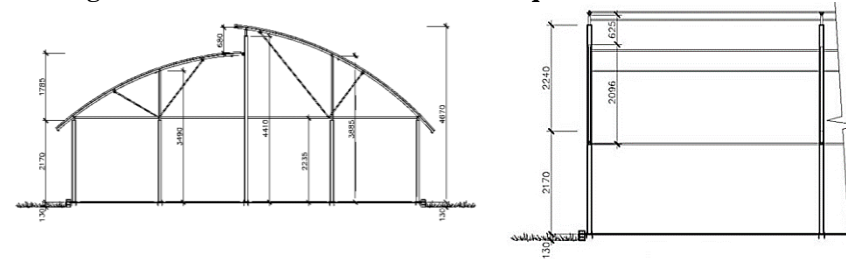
Fachadas Frontal y Lateral de la estructura previa a intervenir y Levantamiento Arquitectónico.
